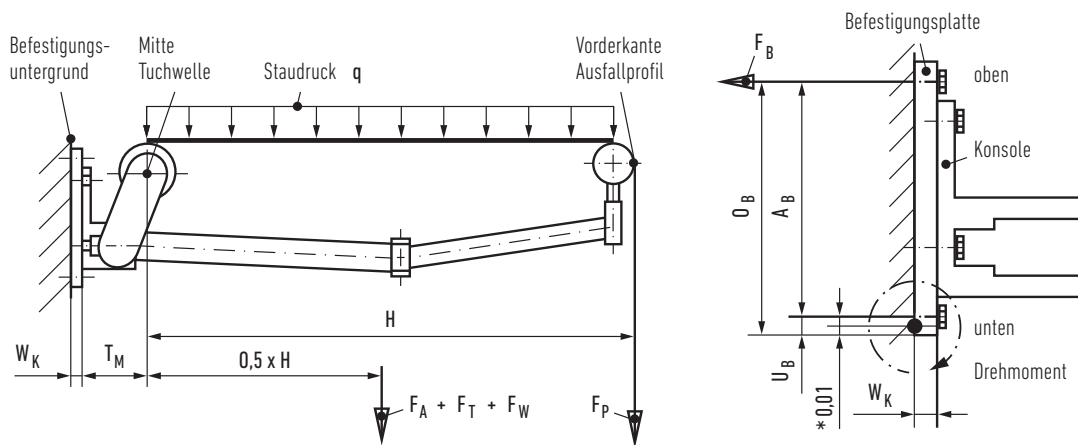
Markisenbefestigung mit Befestigungsplatte
